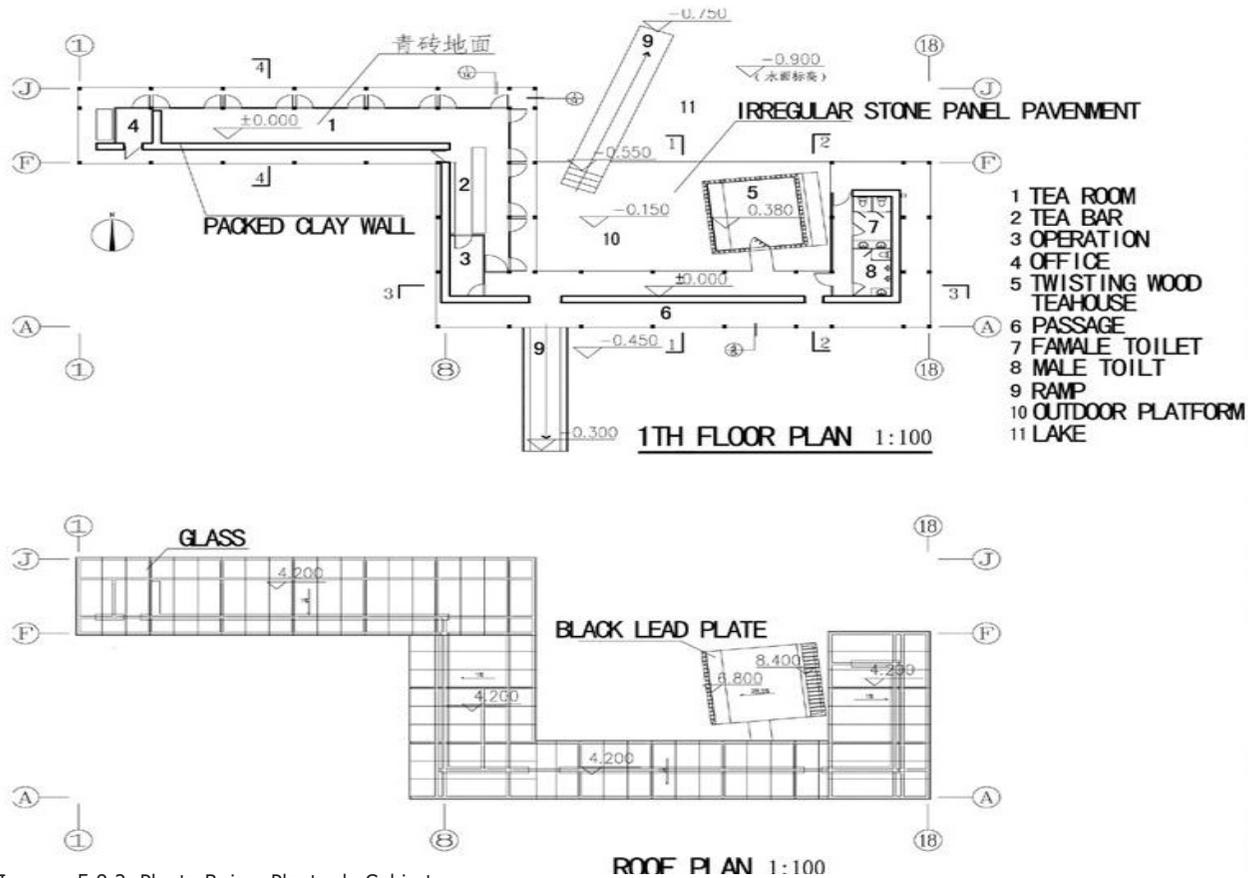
Planta Baja y Planta de Cubiertas.
